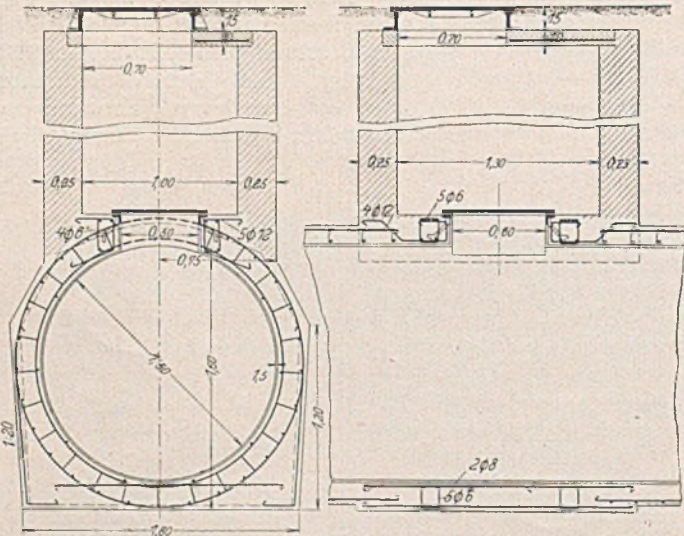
Einsteigeschacht mit Abdeckung. Rohrleitung Owen.
